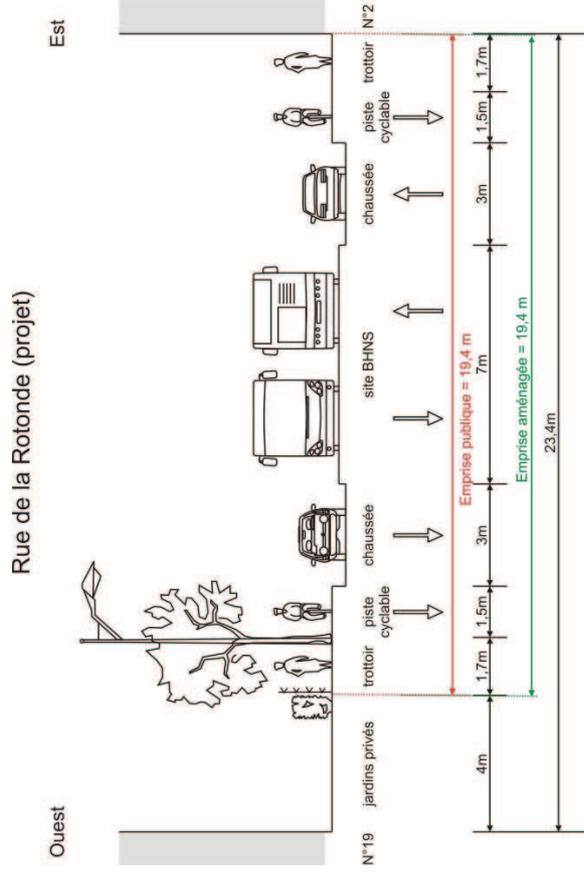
Situation projetée (coupe 32) rue de la Rotonde
